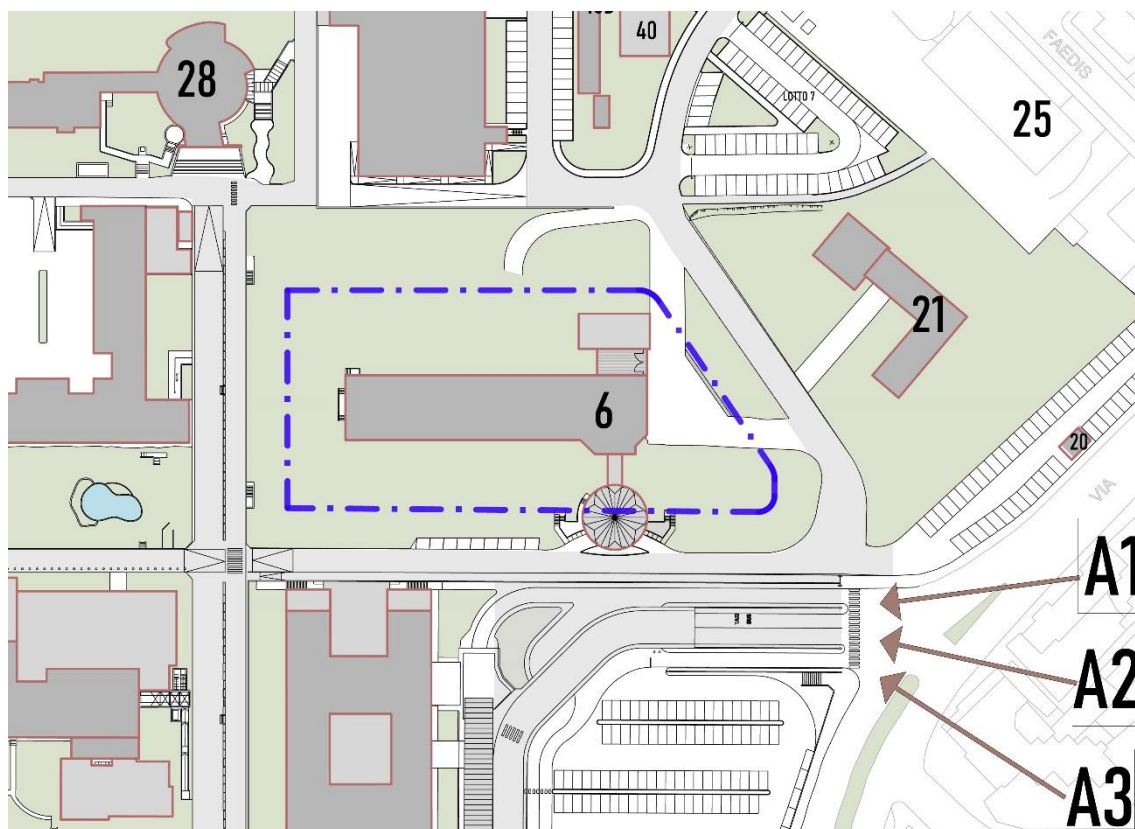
Planimetria dello stato di fatto con indicazione dell'involuppo di edificabilità
